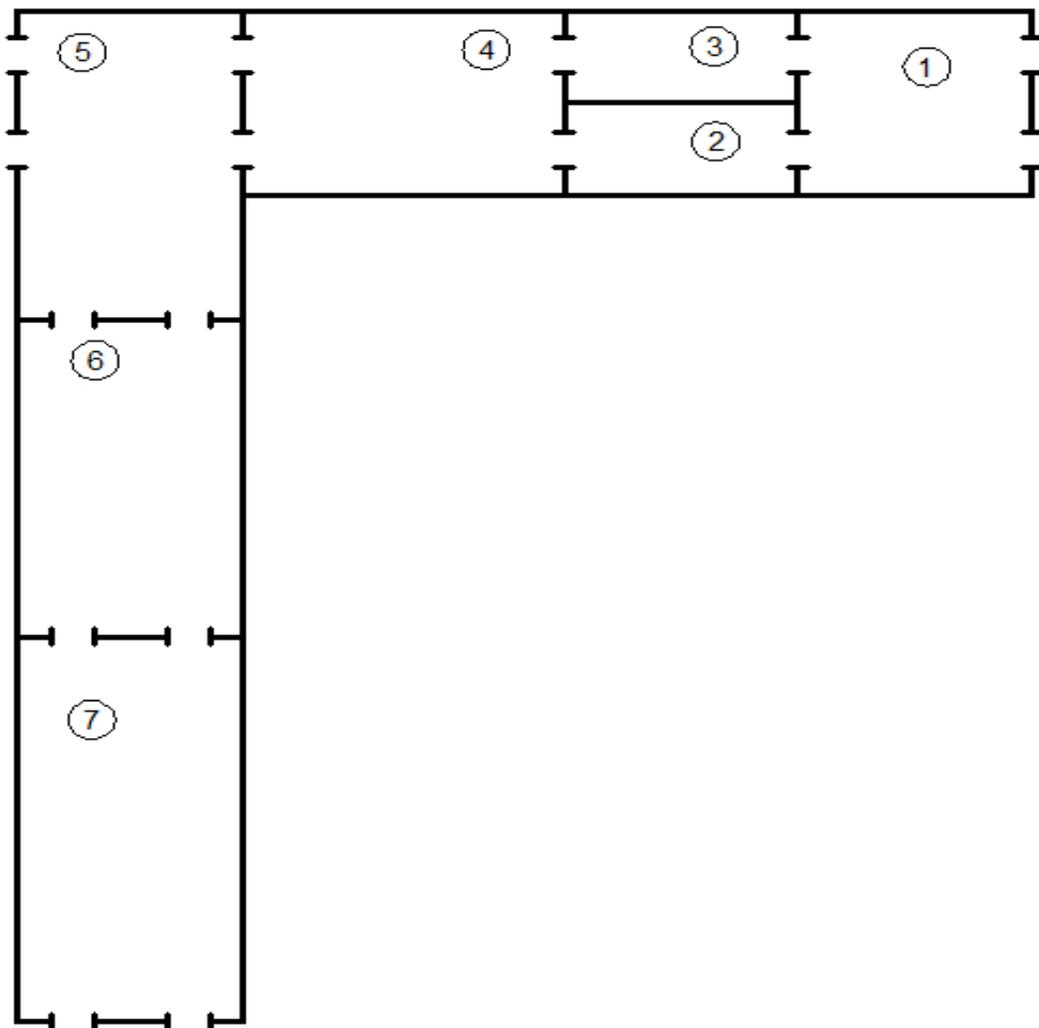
Схематичное расположение отделений заготовительного корпуса завода приборостроения при «Г»-образном блокировании корпусов
